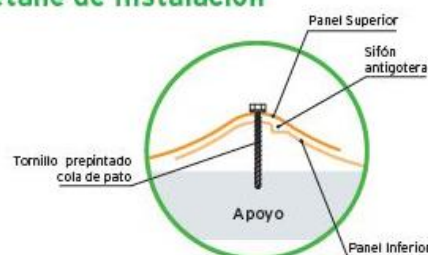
Junta sobrepuesta para panel de cubierta tipo teja
